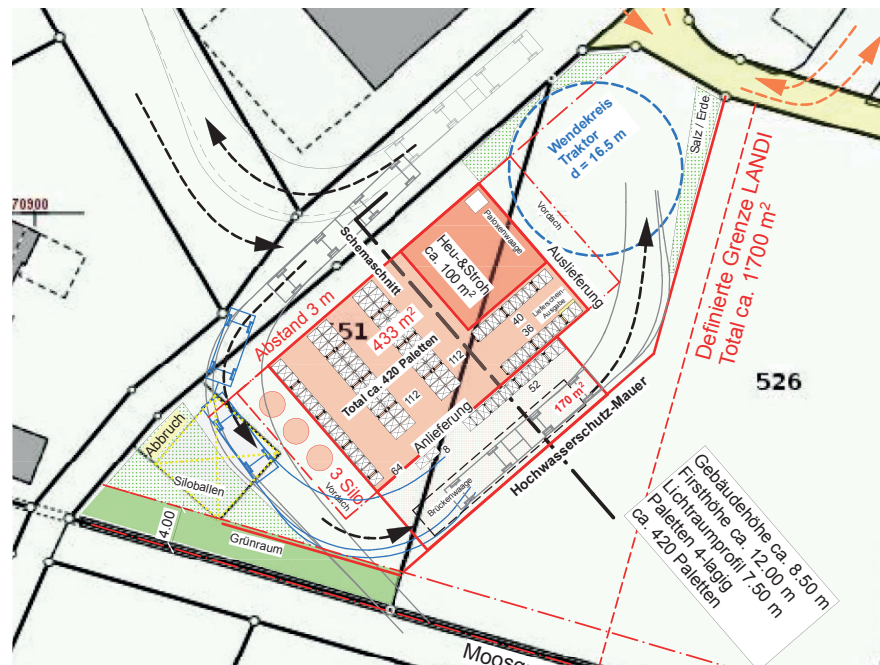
Lagergebäude mit rückwärtiger Anlieferung
